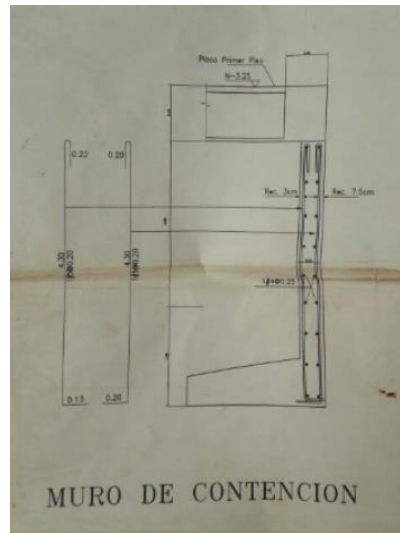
Detalle estructural muro de contención perimetral. Fuente: Camargo Construcciones.
